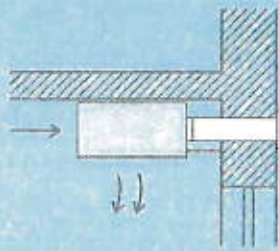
DETAIL INSTALACE A FASÁDNÍCH PROSTUPŮ
